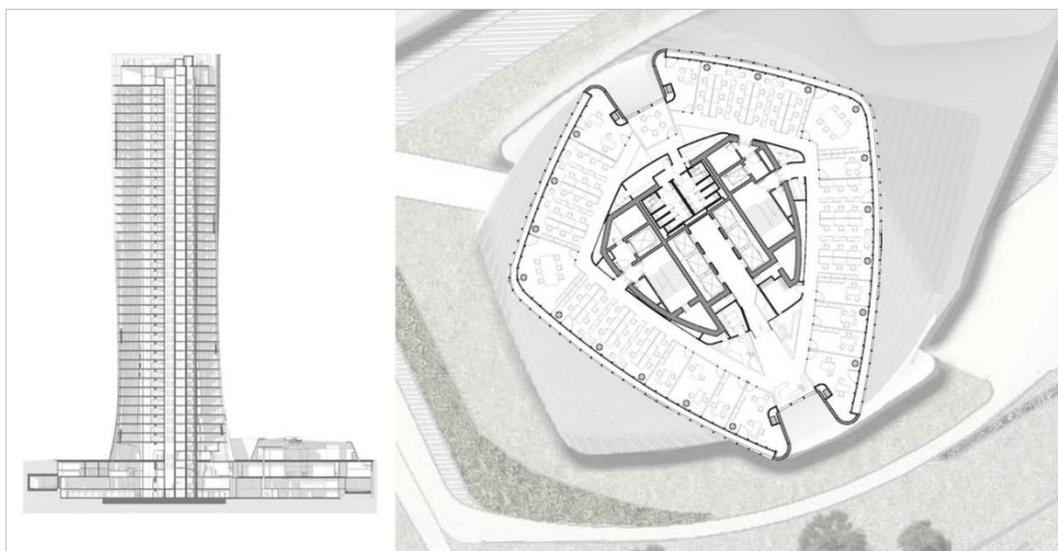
Citylife – Generali Tower (sinistra) sezione trasversale; (destra) planimetria piano 22 (da ingegneri.info)
